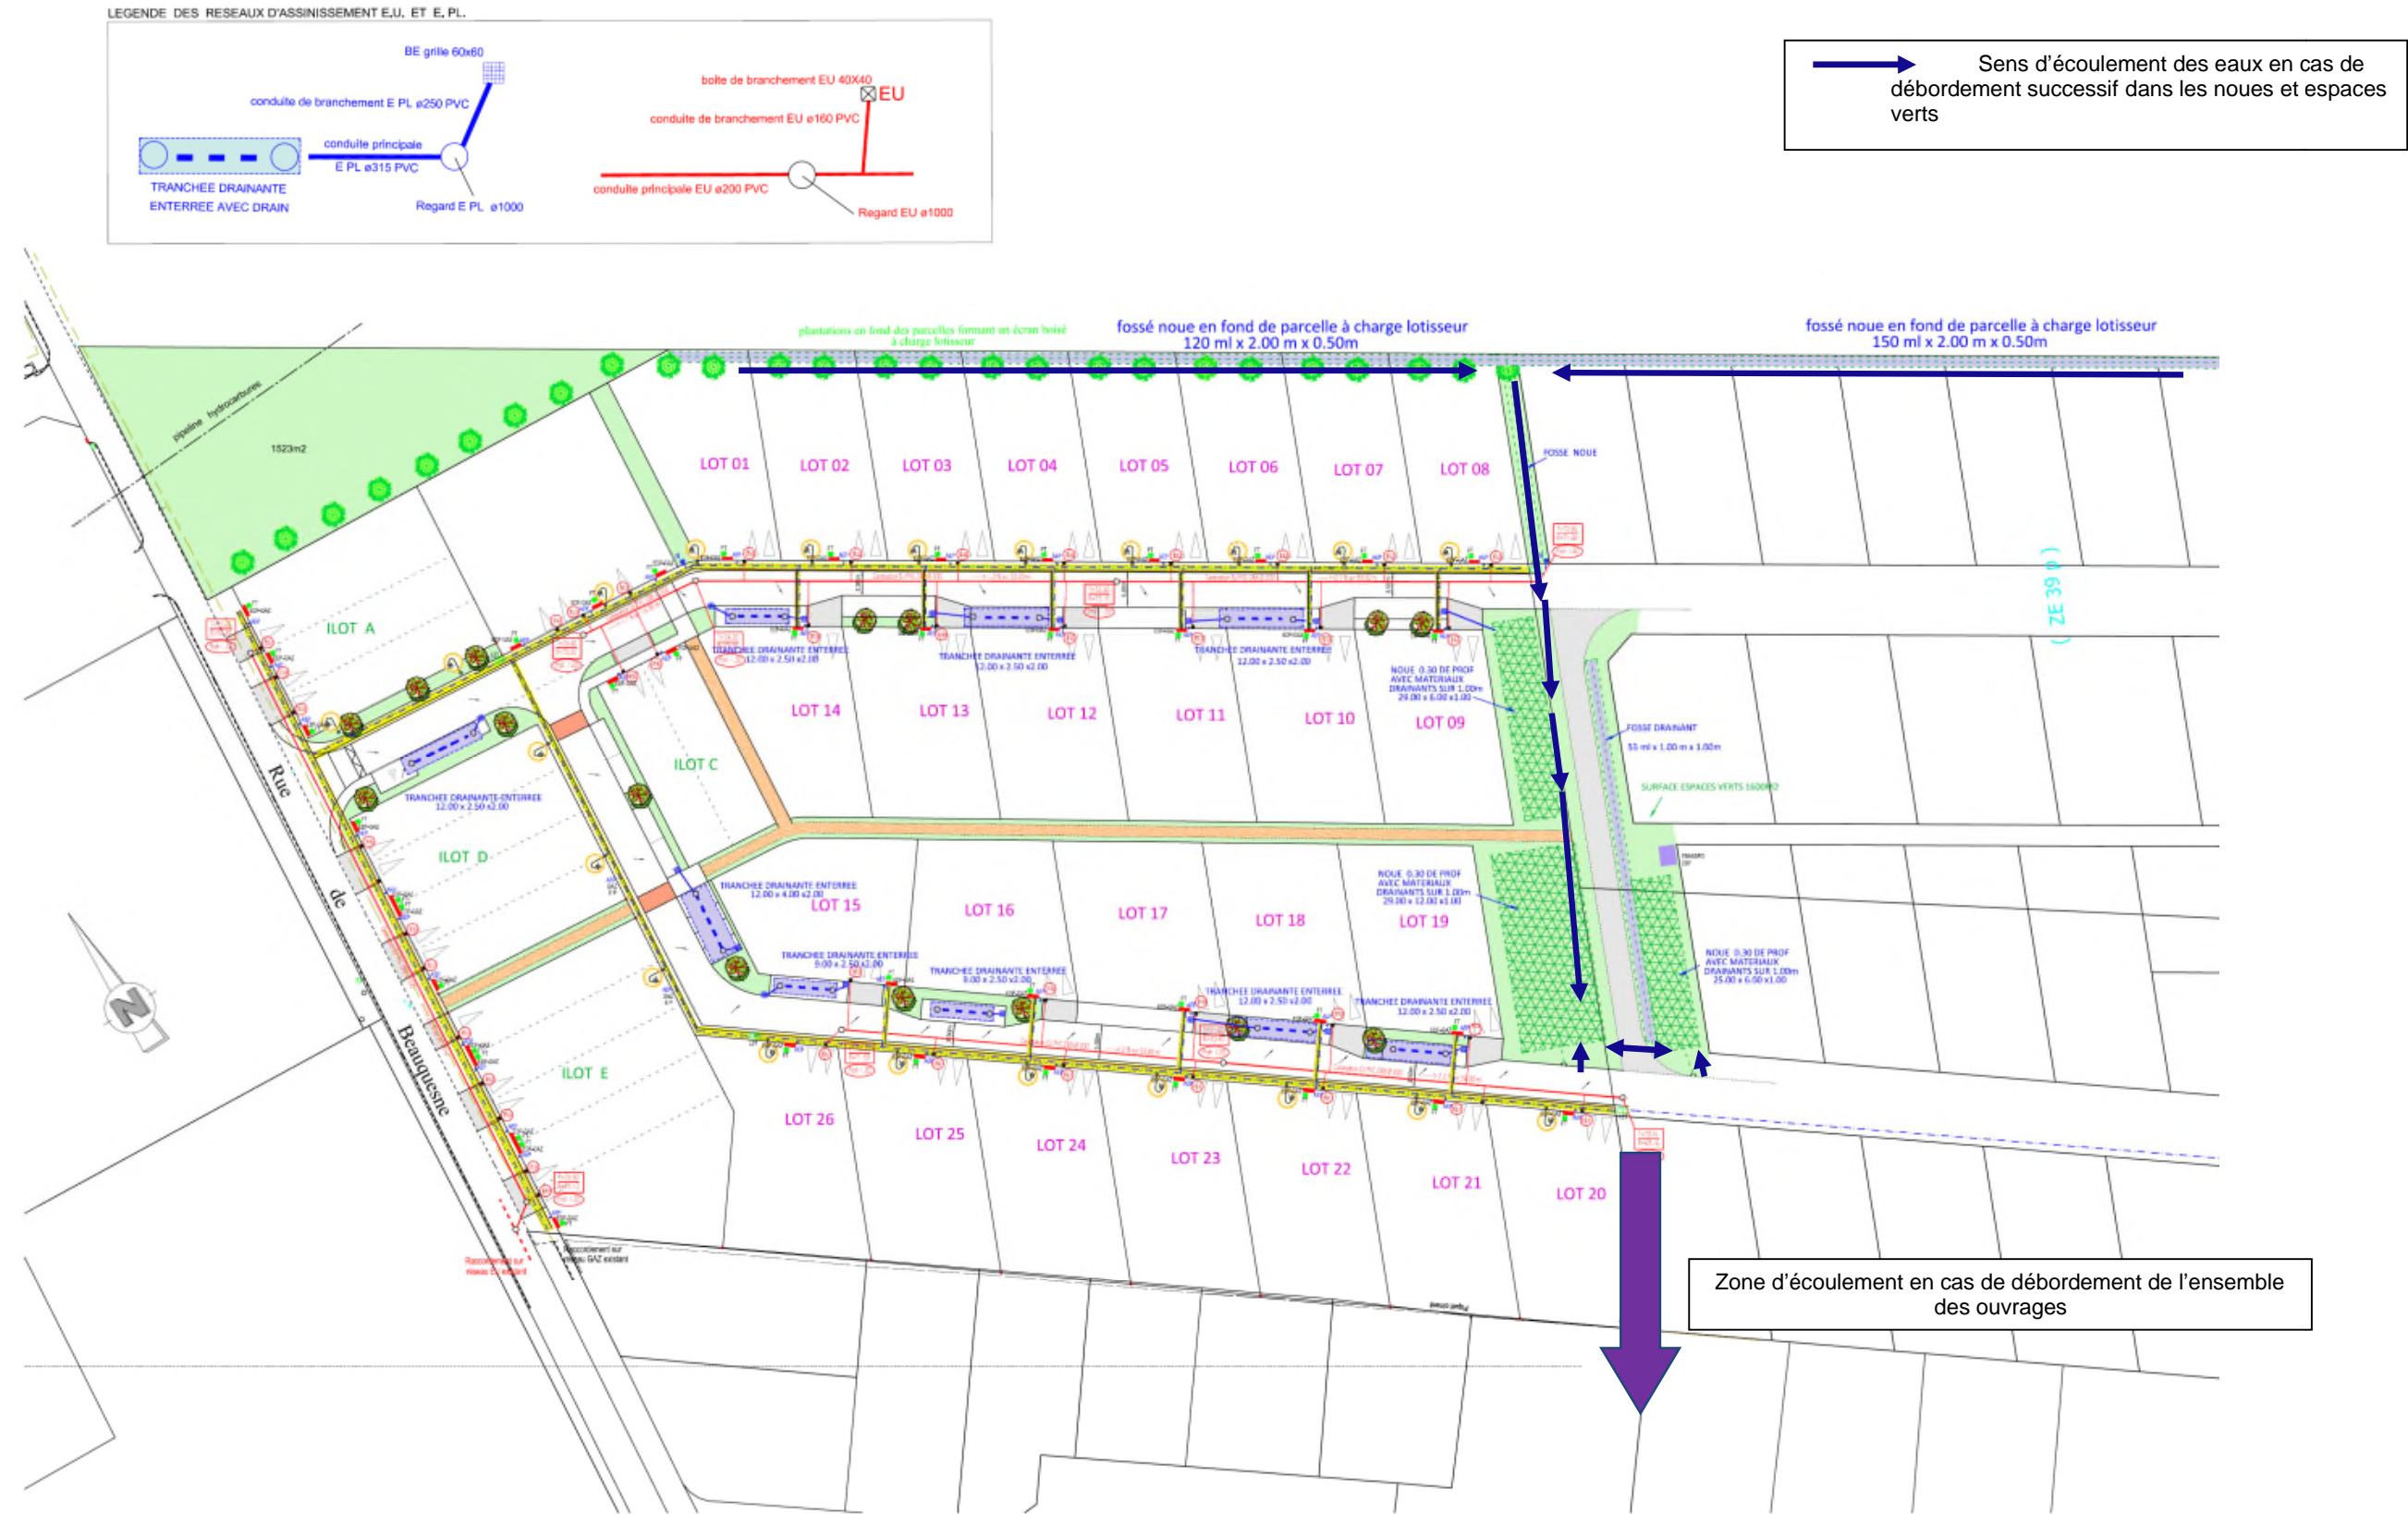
Plan d'assainissement des eaux pluviales (sans échelle)
